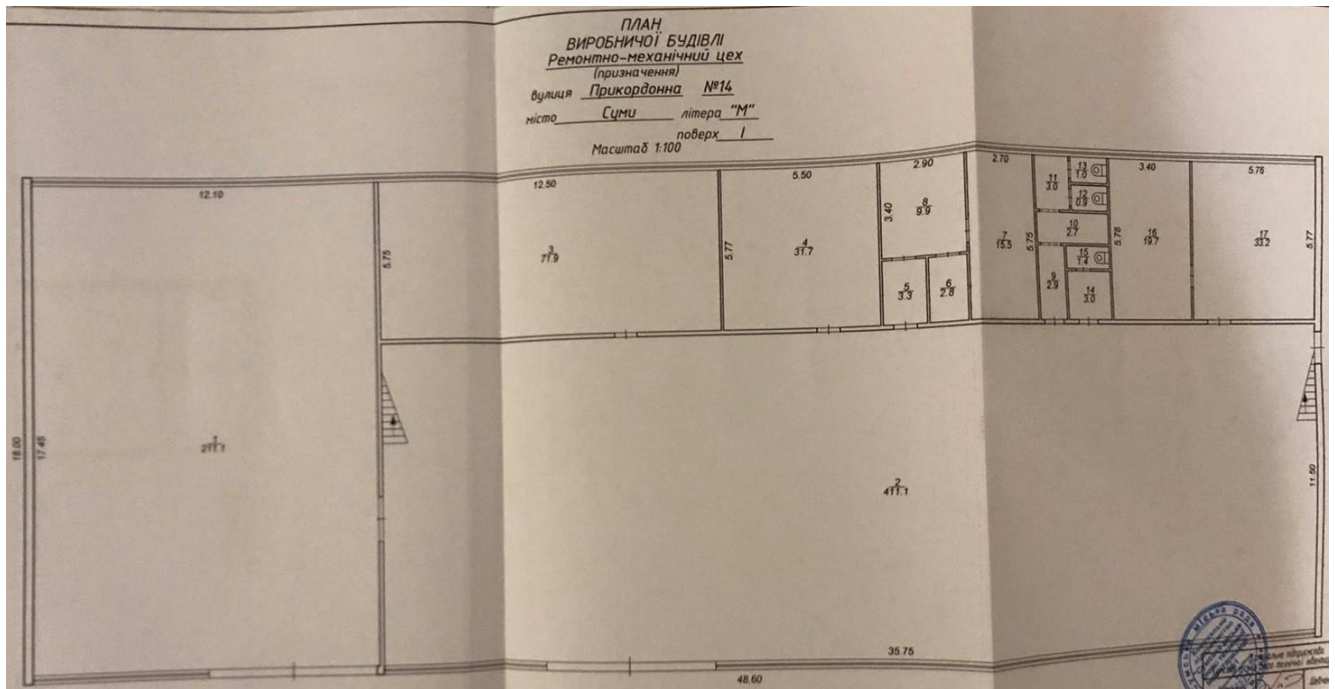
План будівлі ремонтно-механічного цеху
